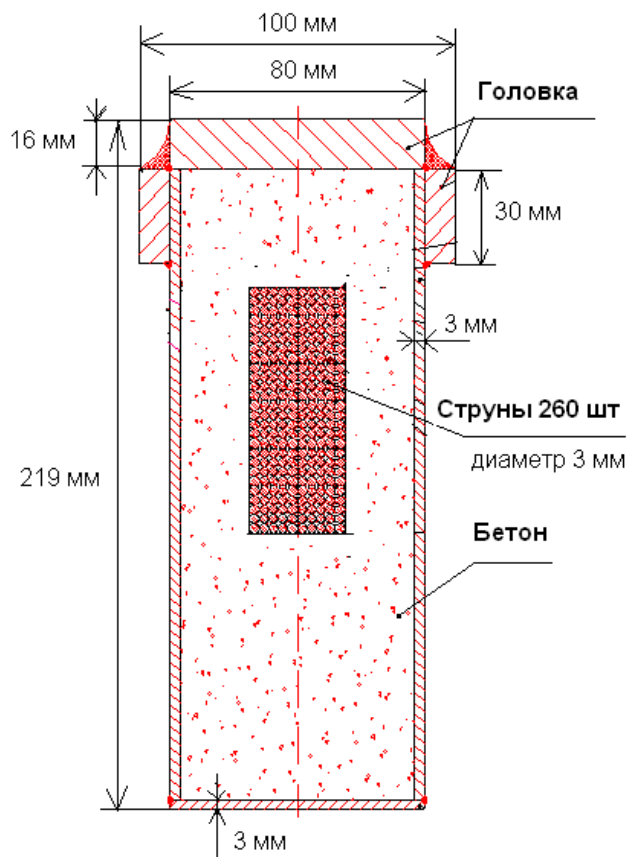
Расчетное поперечное сечение рельса-струны
